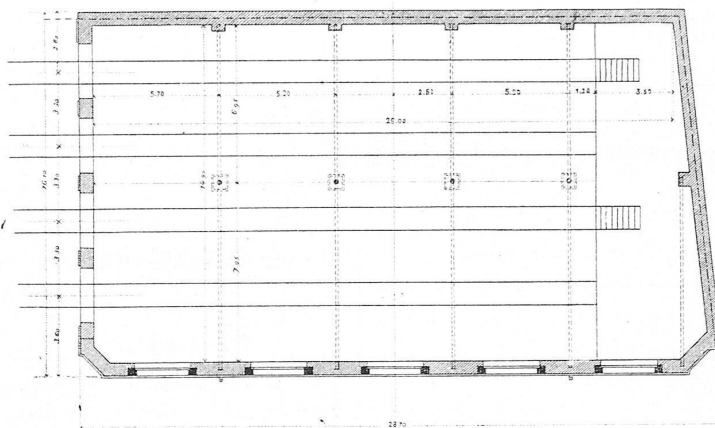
Grundriss vom Erdgeschoss 1:300.
